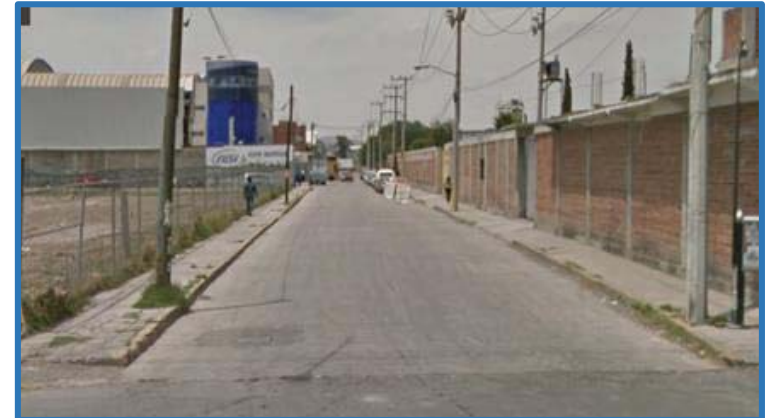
FOTO 5: VISTA CENTRAL DEL TERRENO DESDE CALLE 4ª SUR
